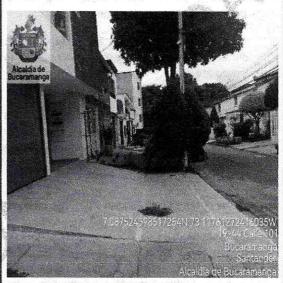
Fachada de inmueble ubicado en la calle 101 No 19-50 Barrio Fontana
